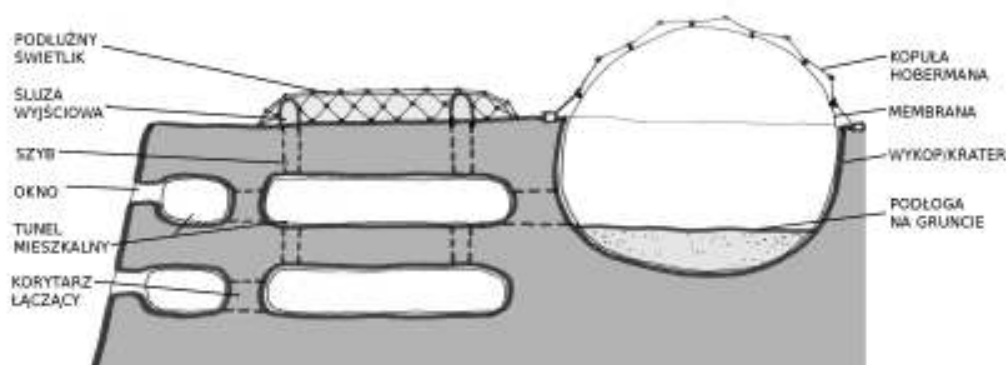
Konceptja 9 – wewnątrz podziemnej konstrukcji
